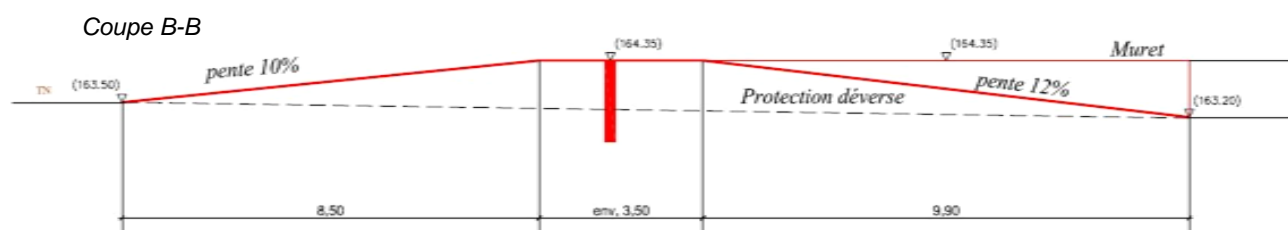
Profil en long de la nouvelle rampe prévue sur le quai Pierre Sémard à Oullins
